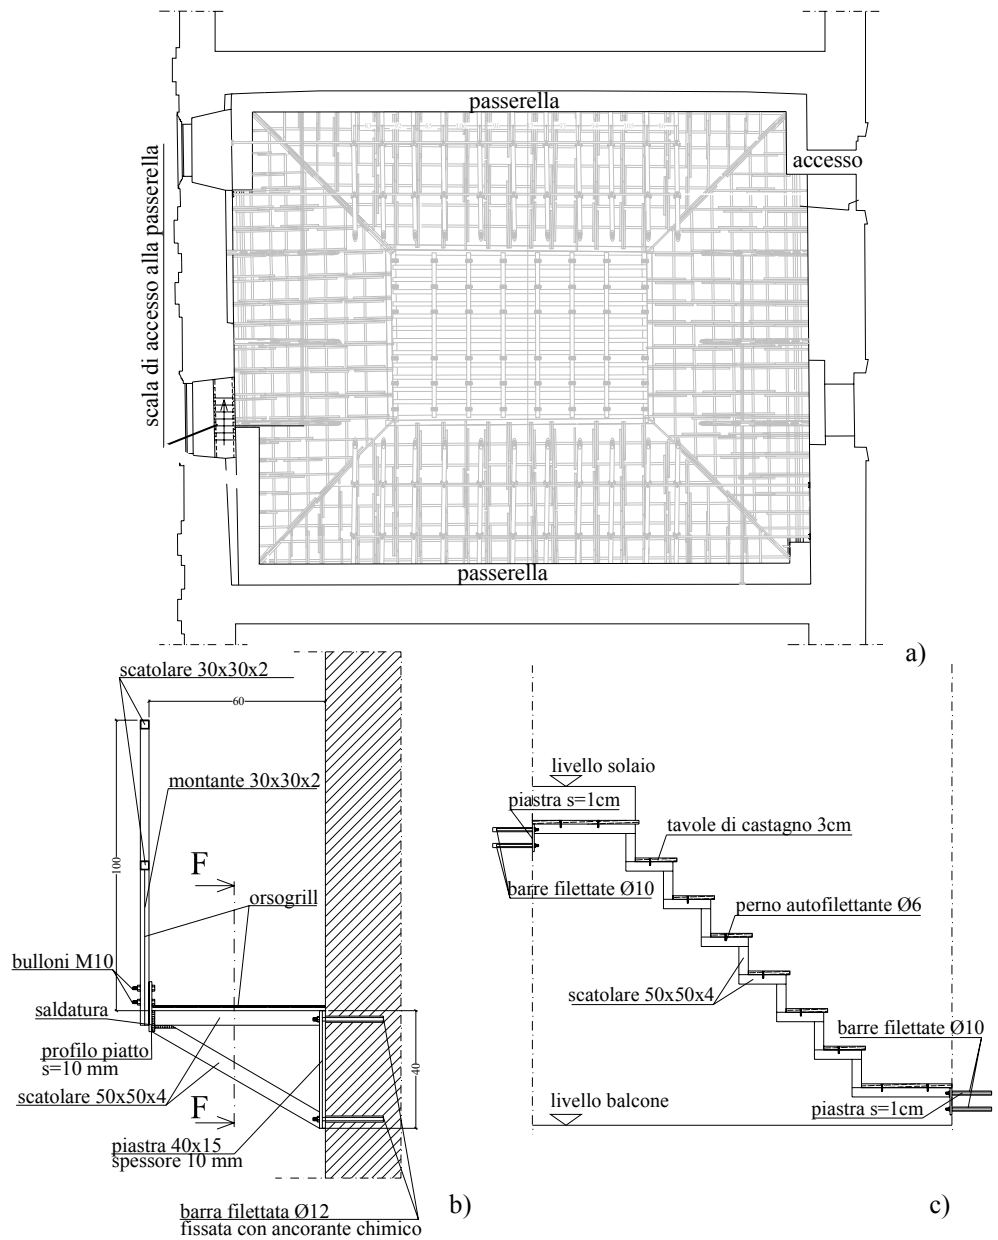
Passerella d'ispezione: a) posizione in pianta; b) Sezione; c) Scala di accesso.
